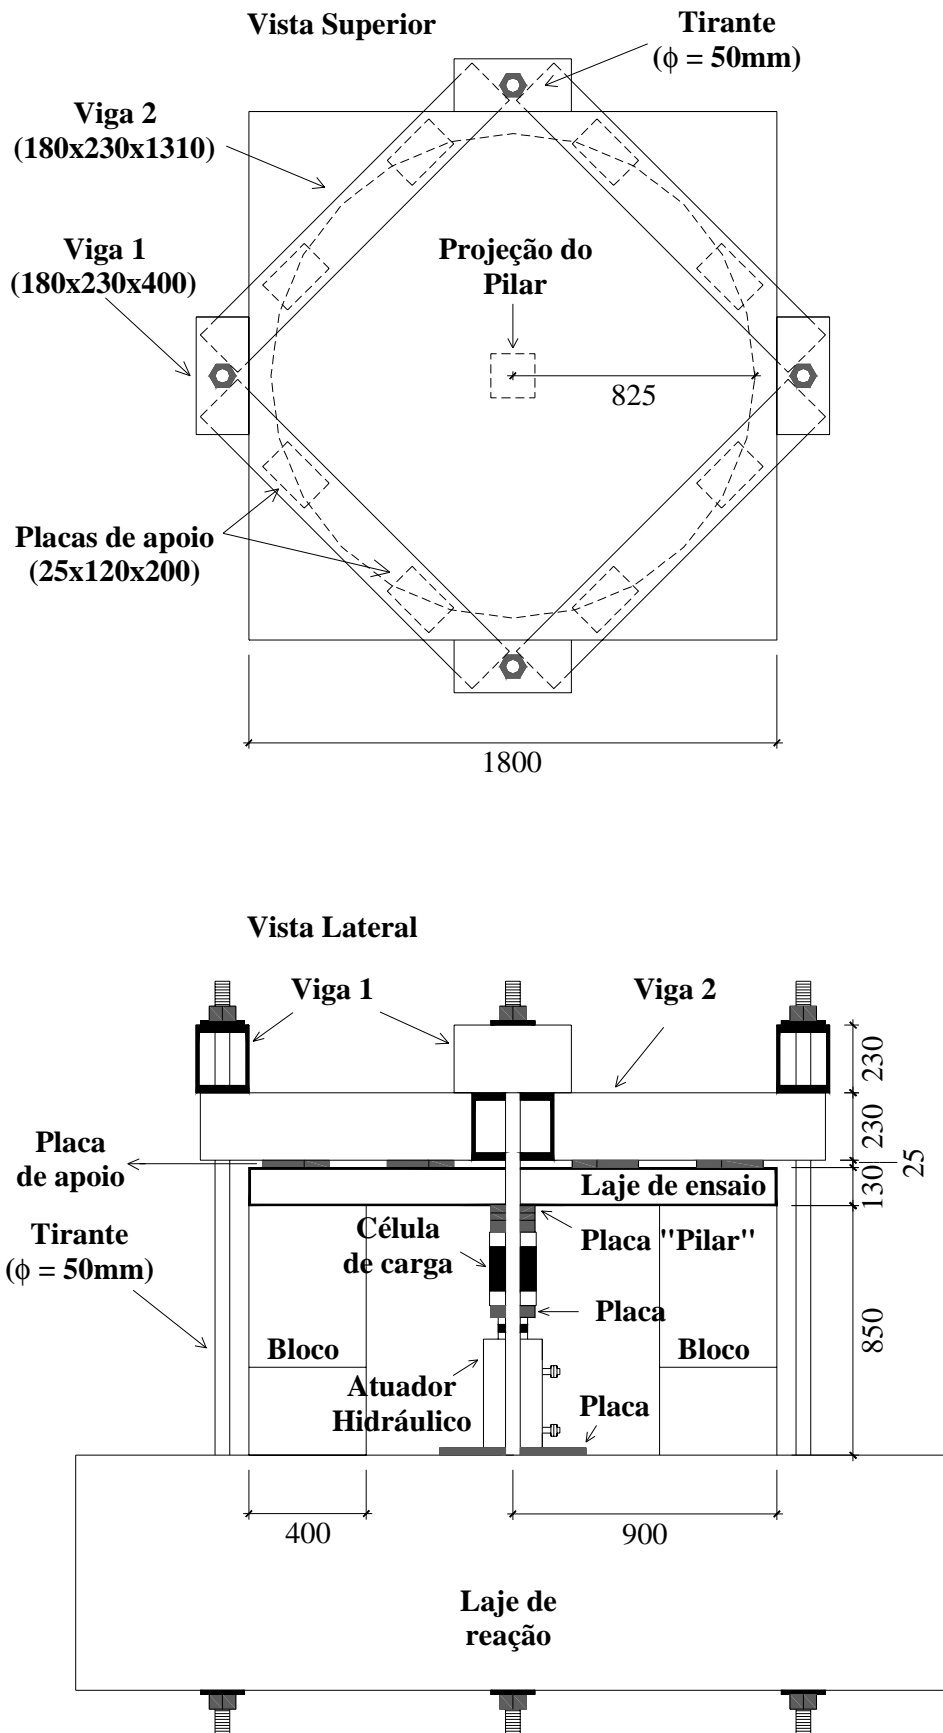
Sistema de ensaio utilizado por SILVA (2003) (mm)
